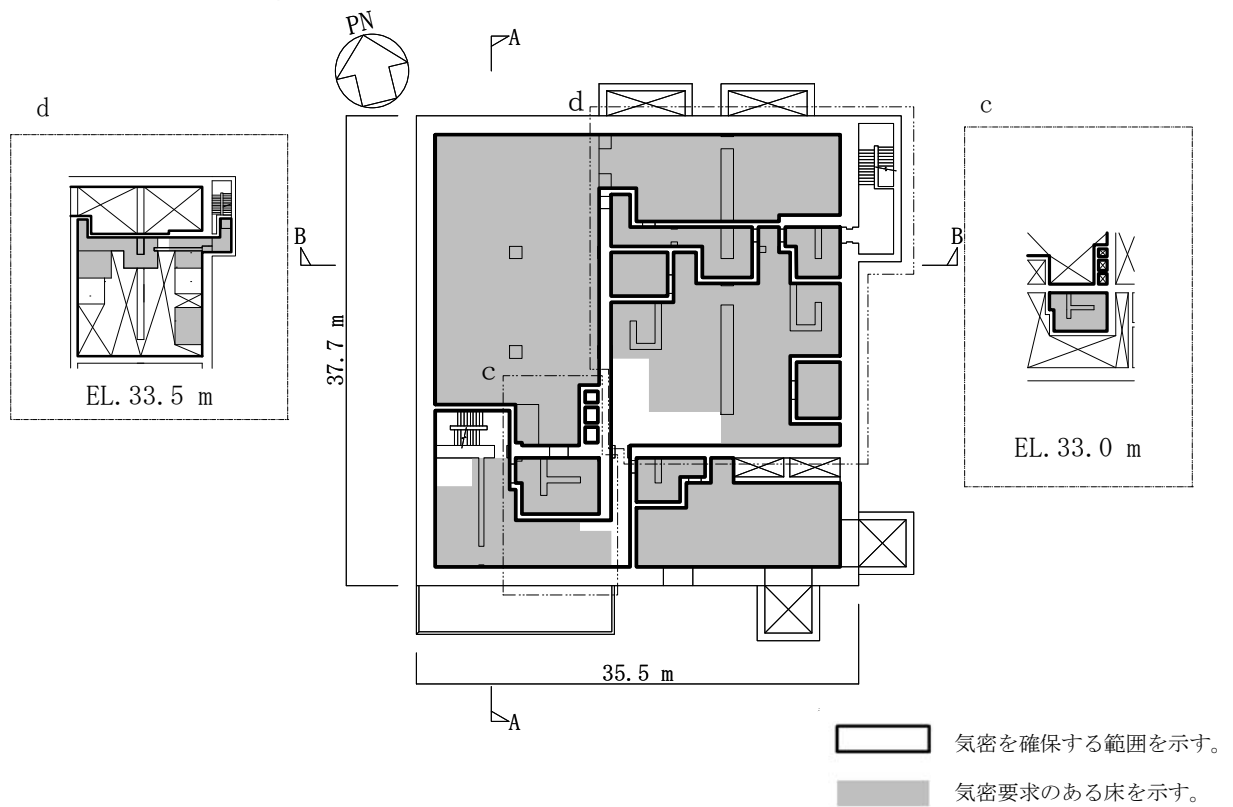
(2/7) 気密性を確保する範囲 (2 階平面図 : EL. 30.3 m)
